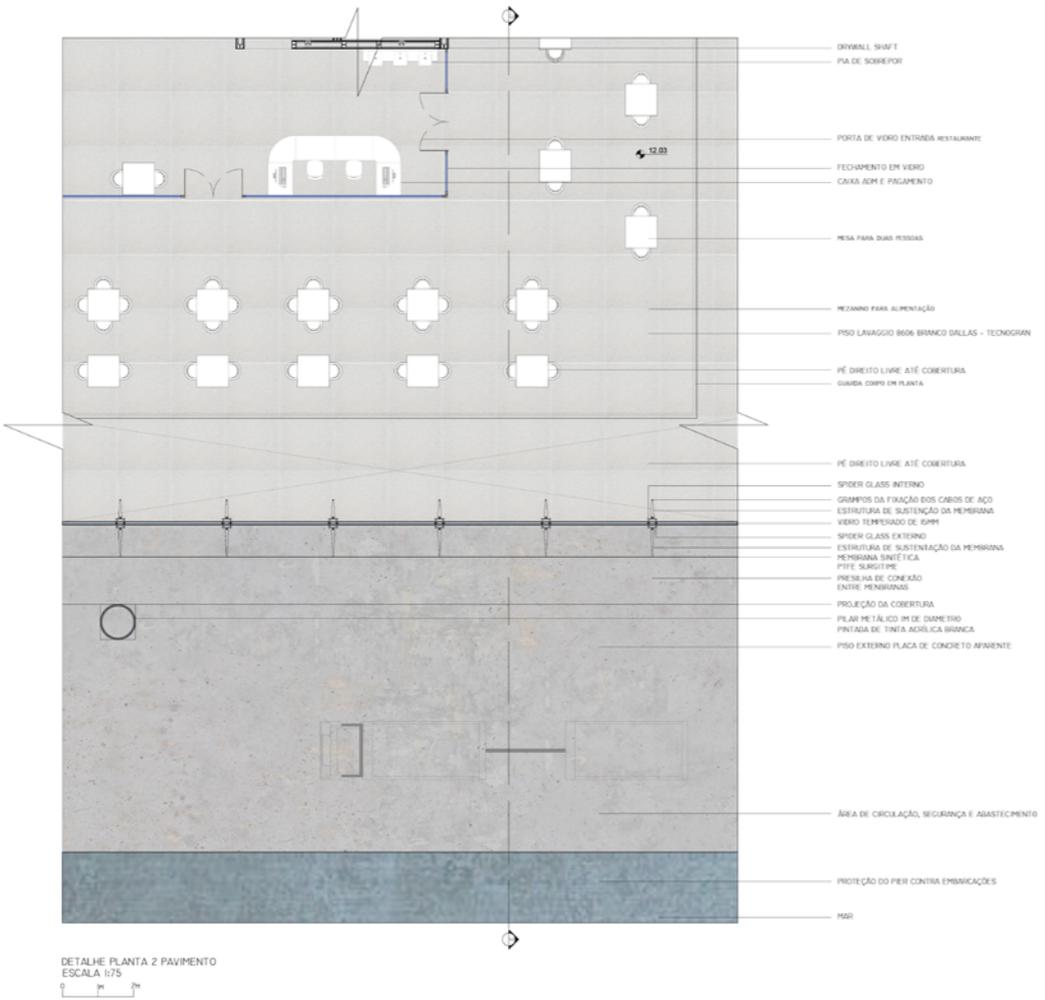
Ampliação da planta do segundo pavimento em 1:75, ajustada. Fonte: Autoria própria
